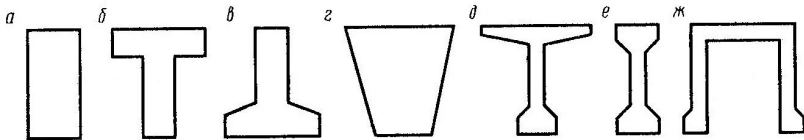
Поперечные сечения балок: *a* – прямоугольное; *б*, *в* – тавровые; *г* – трапециевидное; *д* – двутавровое; *е* – рельсовидное; *ж* – П-образное.
